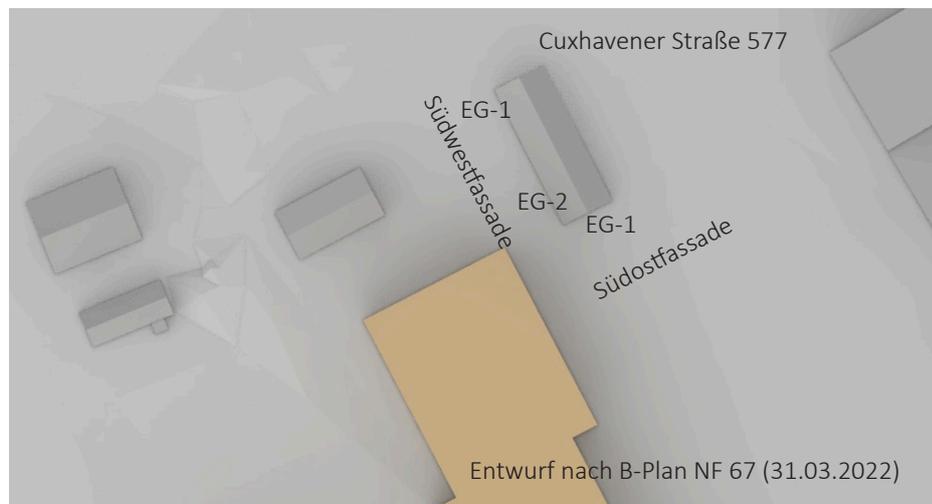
Draufsicht - Cuxhavener Straße 577 - B-Plan NF67; 31.03.2022
